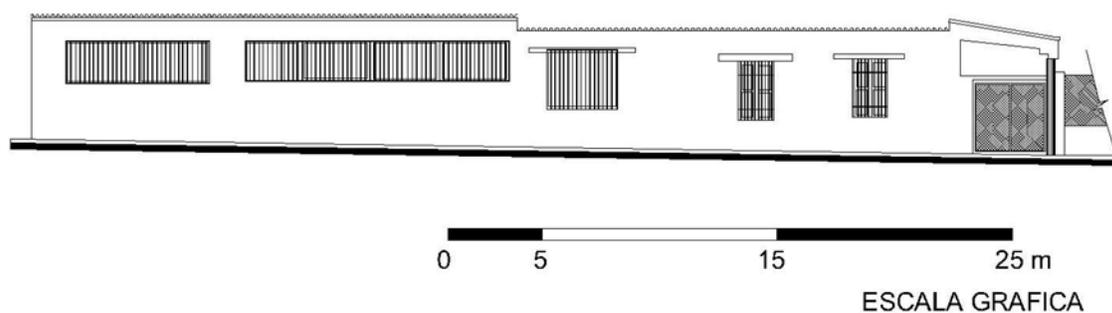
Fachada Sureste: Esta fachada es la que se encuentra menos alterada.
